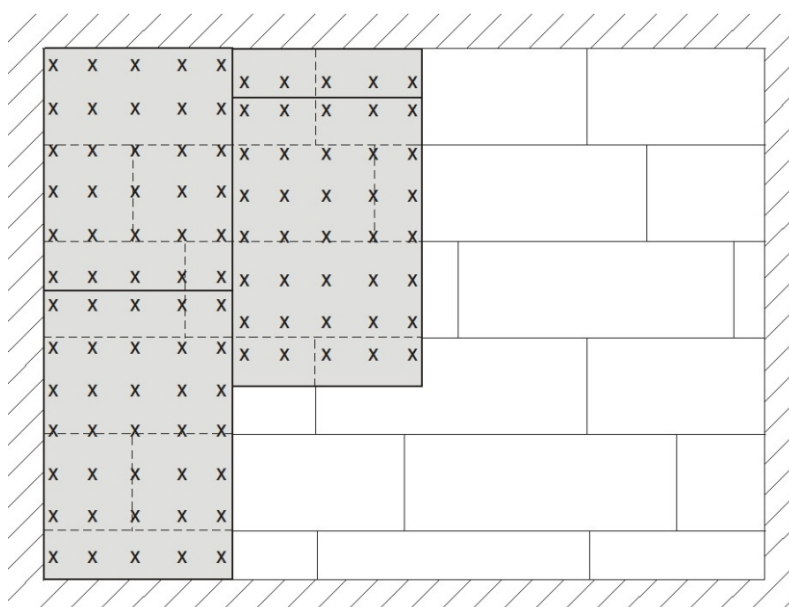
Plan de pose 3 Recouvrement des plaques de sol
